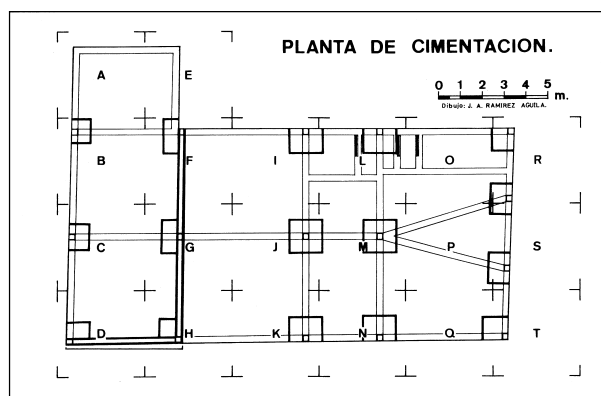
Planteamiento de las cuadrículas sobre la planta de cimentación del proyecto.
